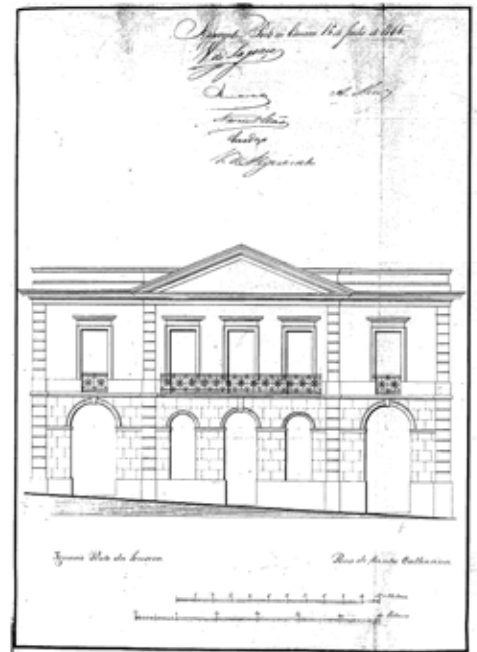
, 2 e 3 - Desenho da fachada anexo ao pedido de construção, 1845²⁵; Fachada do Jornal O Primeiro de Janeiro²⁶; Fachada atual do ViaCatarinaShopping, 2019.
